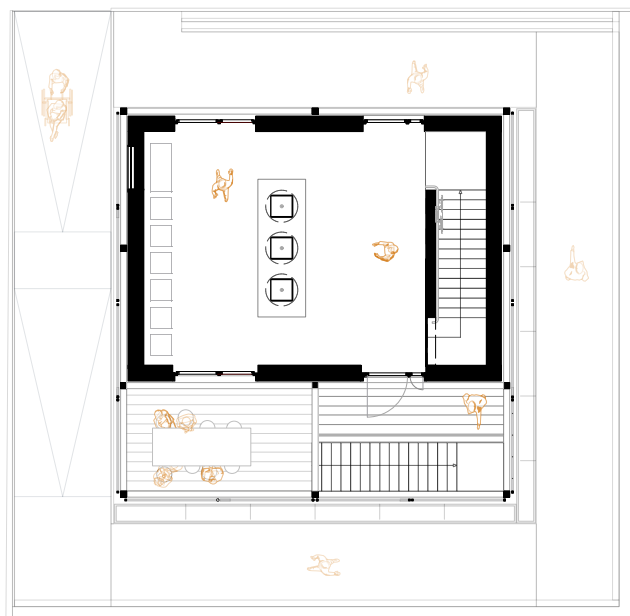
Grundriss Obergeschoss HDU – 1:200
